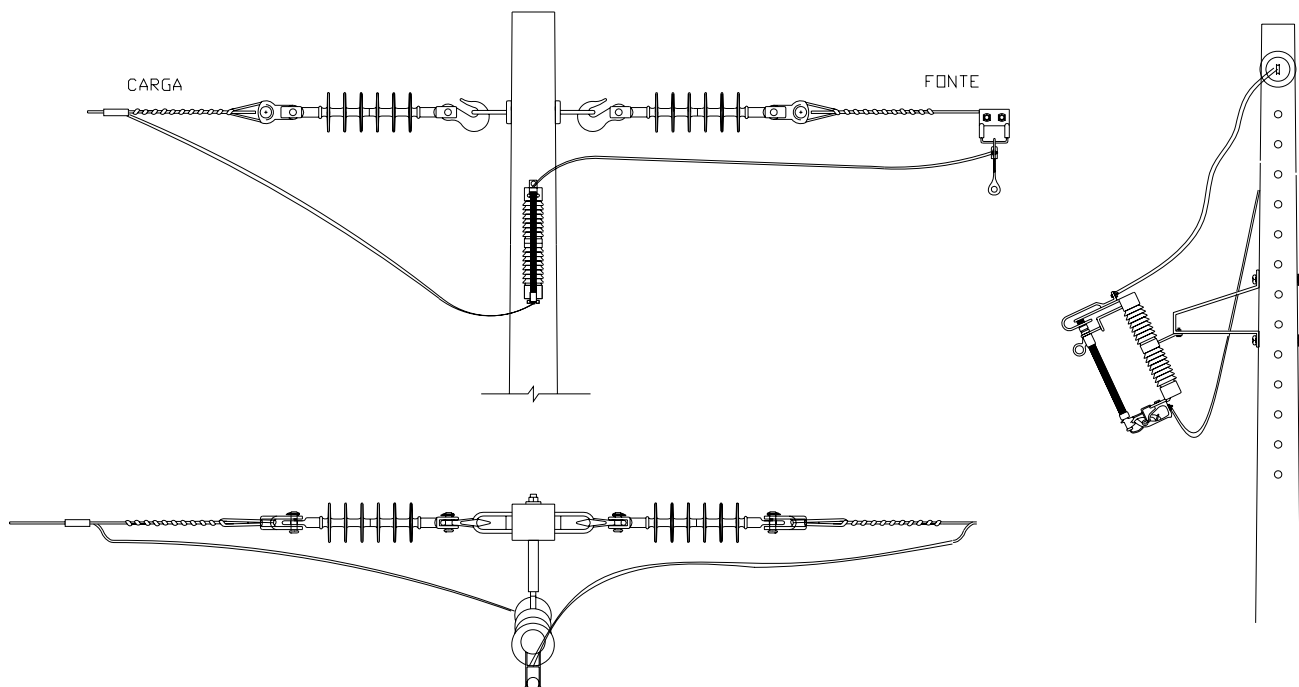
Estrutura U4 chave fusível (proteção) (montagem alternativa)
